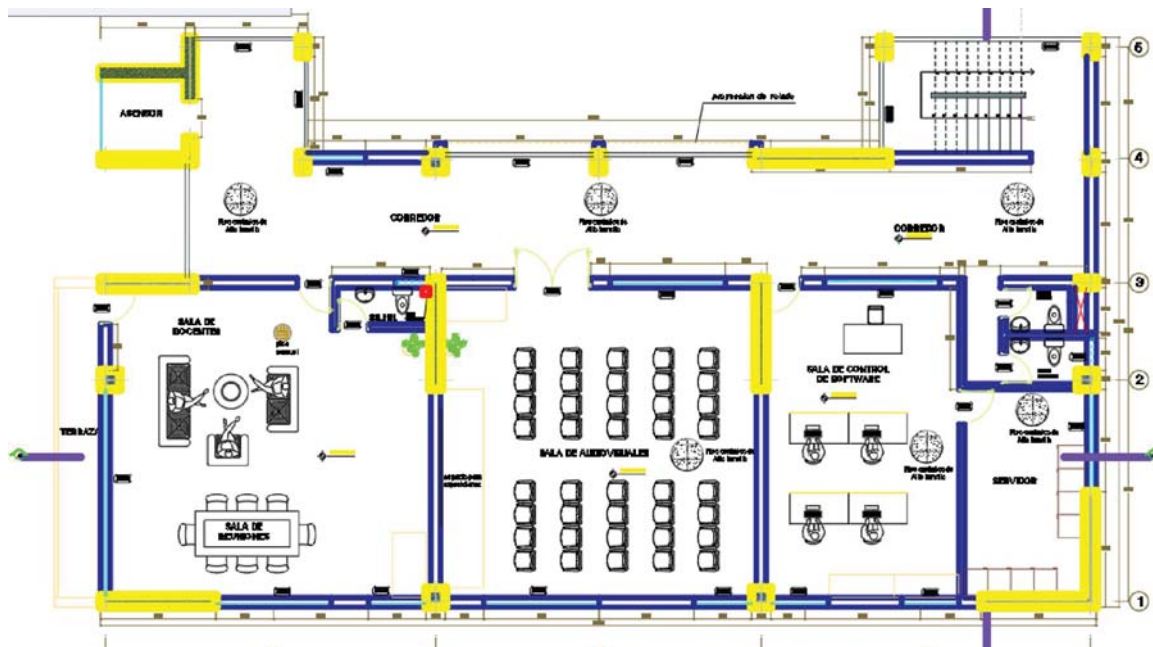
PLANTA DE DISTRIBUCION 4TO NIVEL
